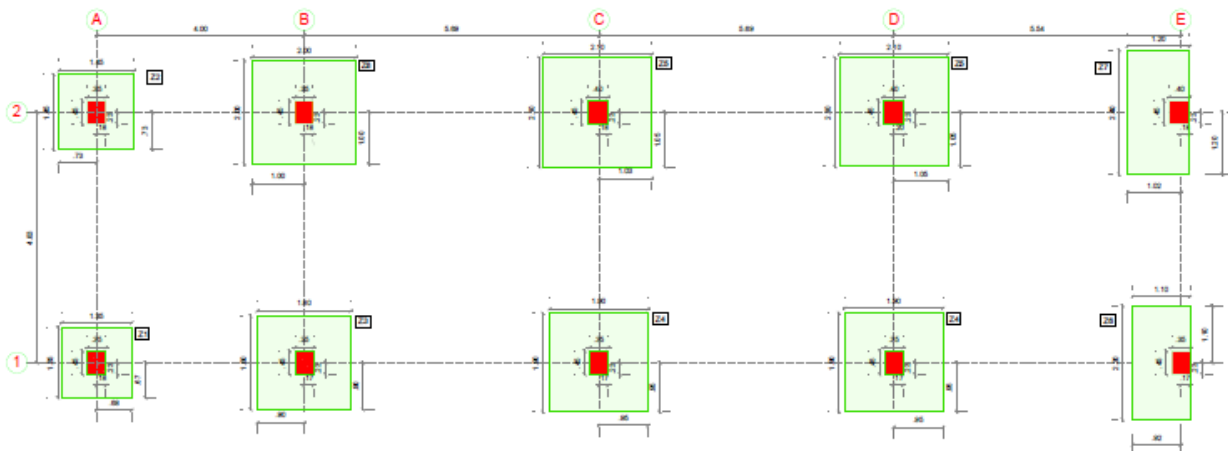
Distribución Modificada de Zapatas en Planta.
